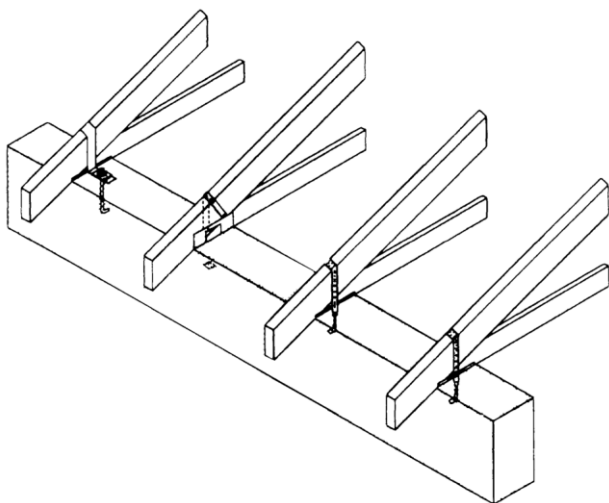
Торцевая бетонная стенка с установленными креплениями для ферм (SEMCO)
